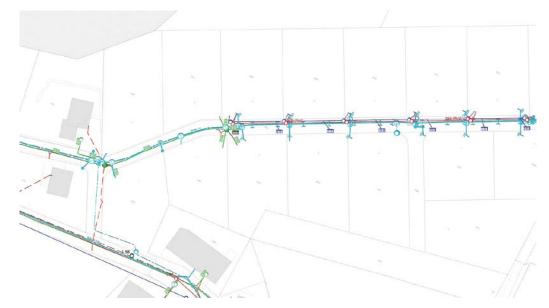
Plan des conduites souterraines réalisées au 05.03.2019 : eau potable, eaux claires et eaux usées, téléphone, électricité. (Source : SITN)
